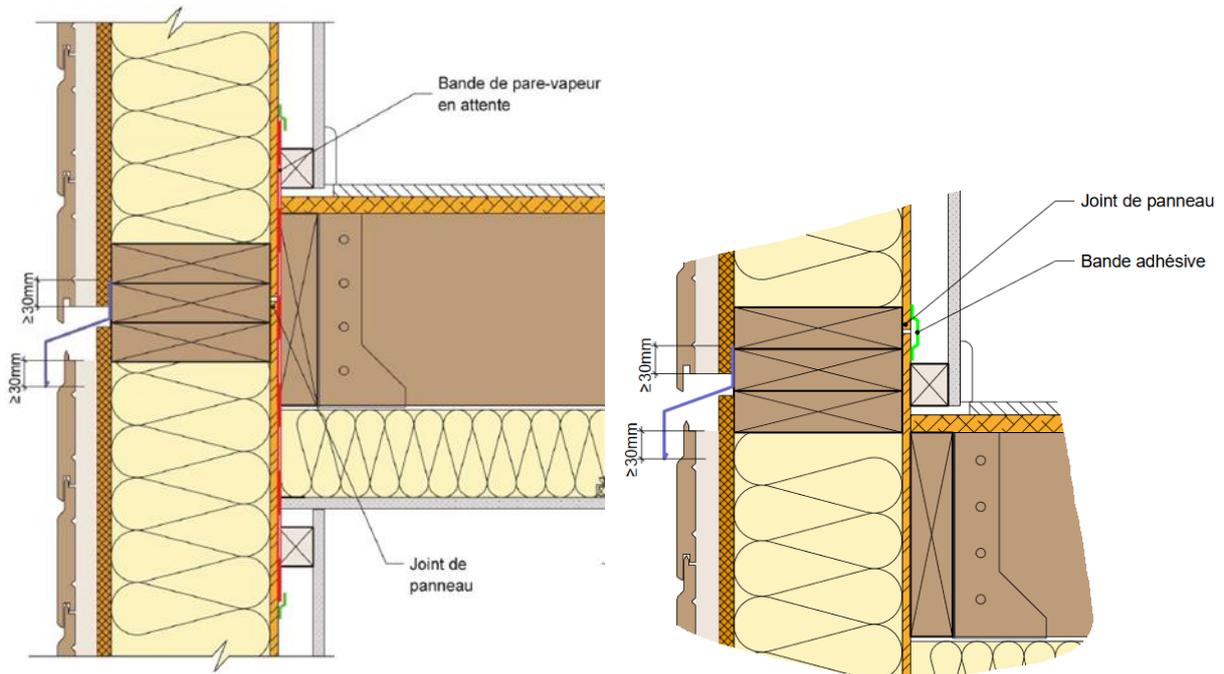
Exemple de jonction au droit d'un plancher d'étage sur muraille (coupe verticale)
